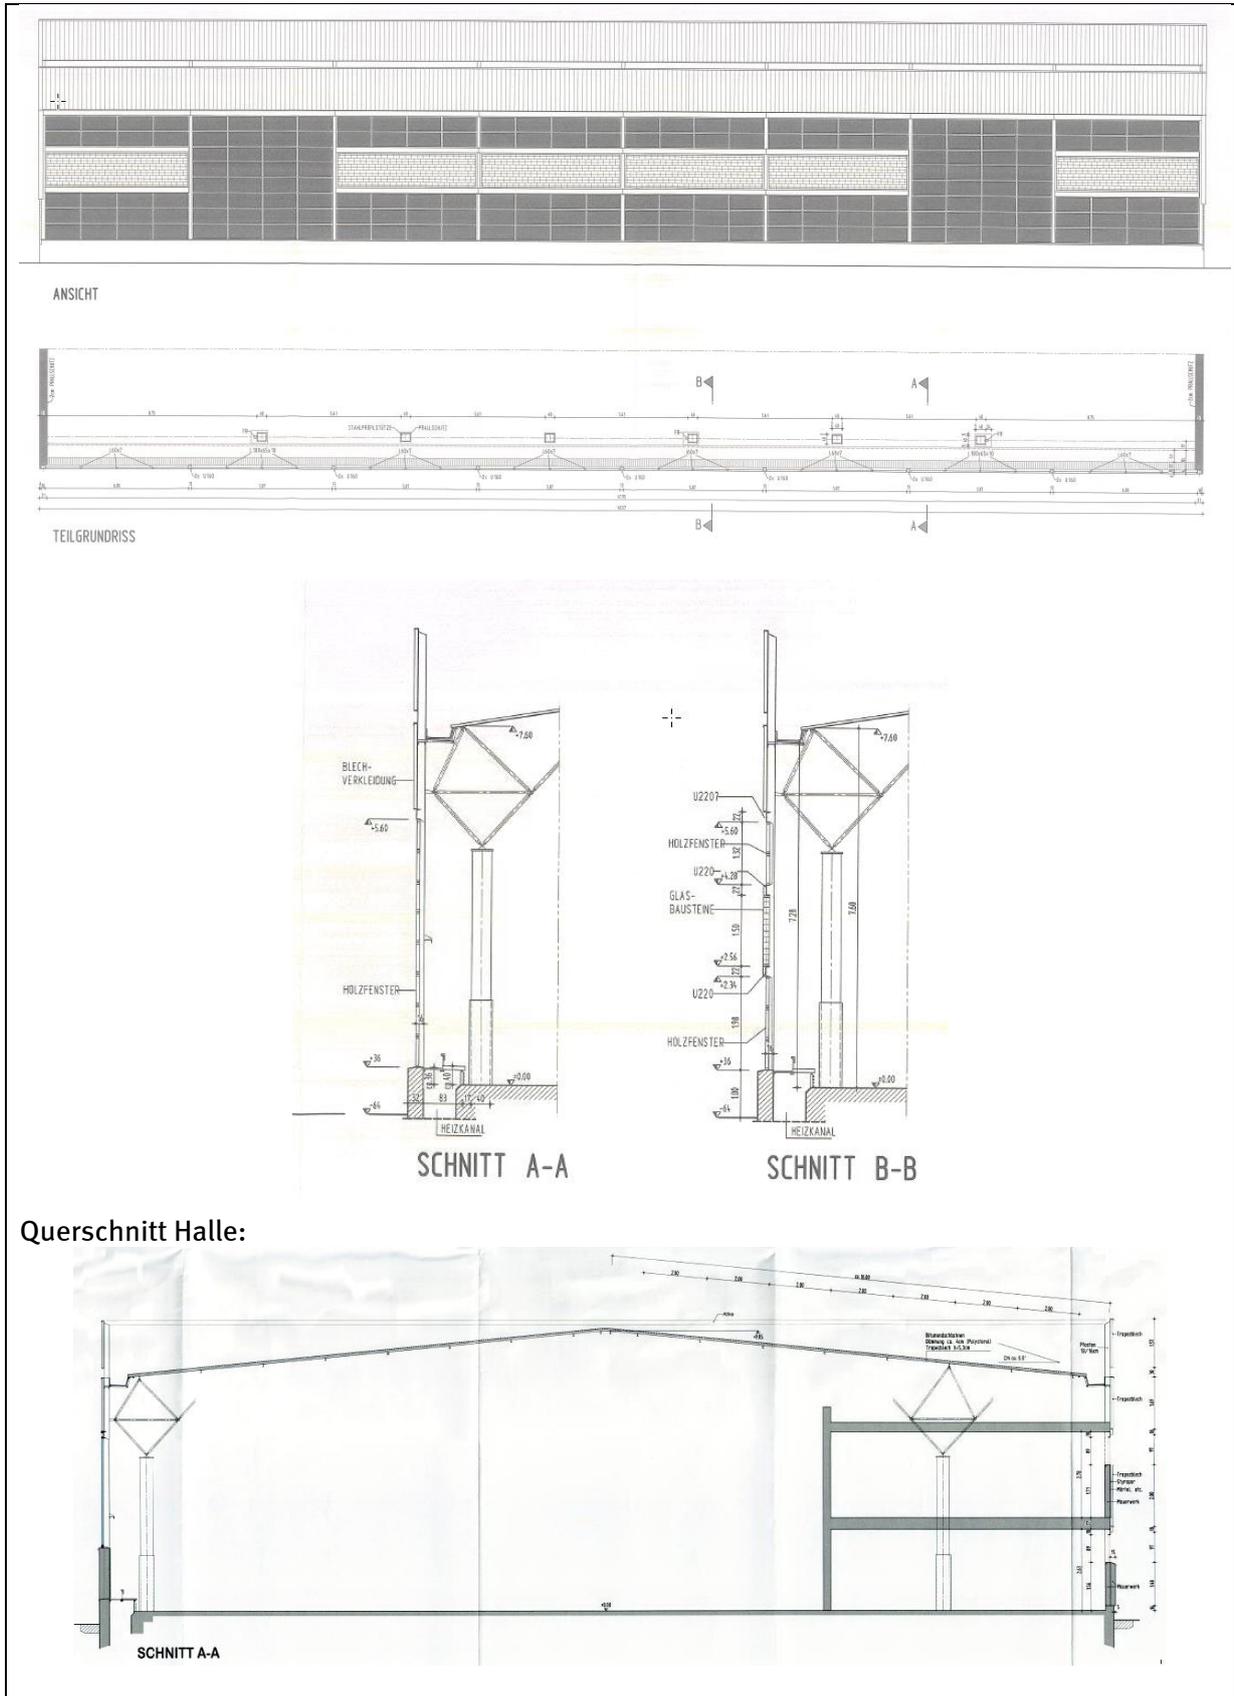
Schnitt durch Fassade Halle 19 - Typ GT 75 L
